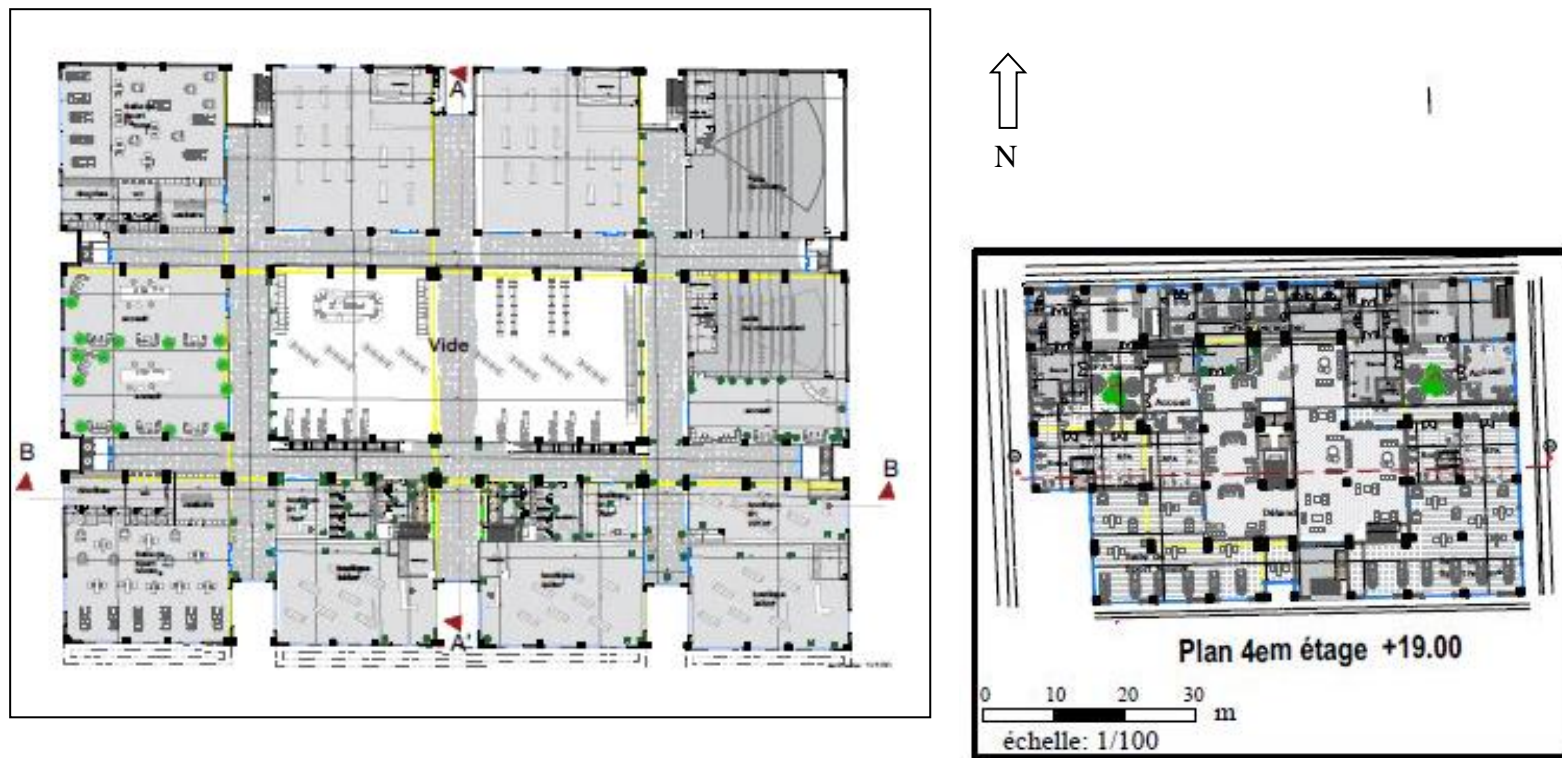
Plan de 4eme étage+22.00/Source : Traiter par l'auteur.
